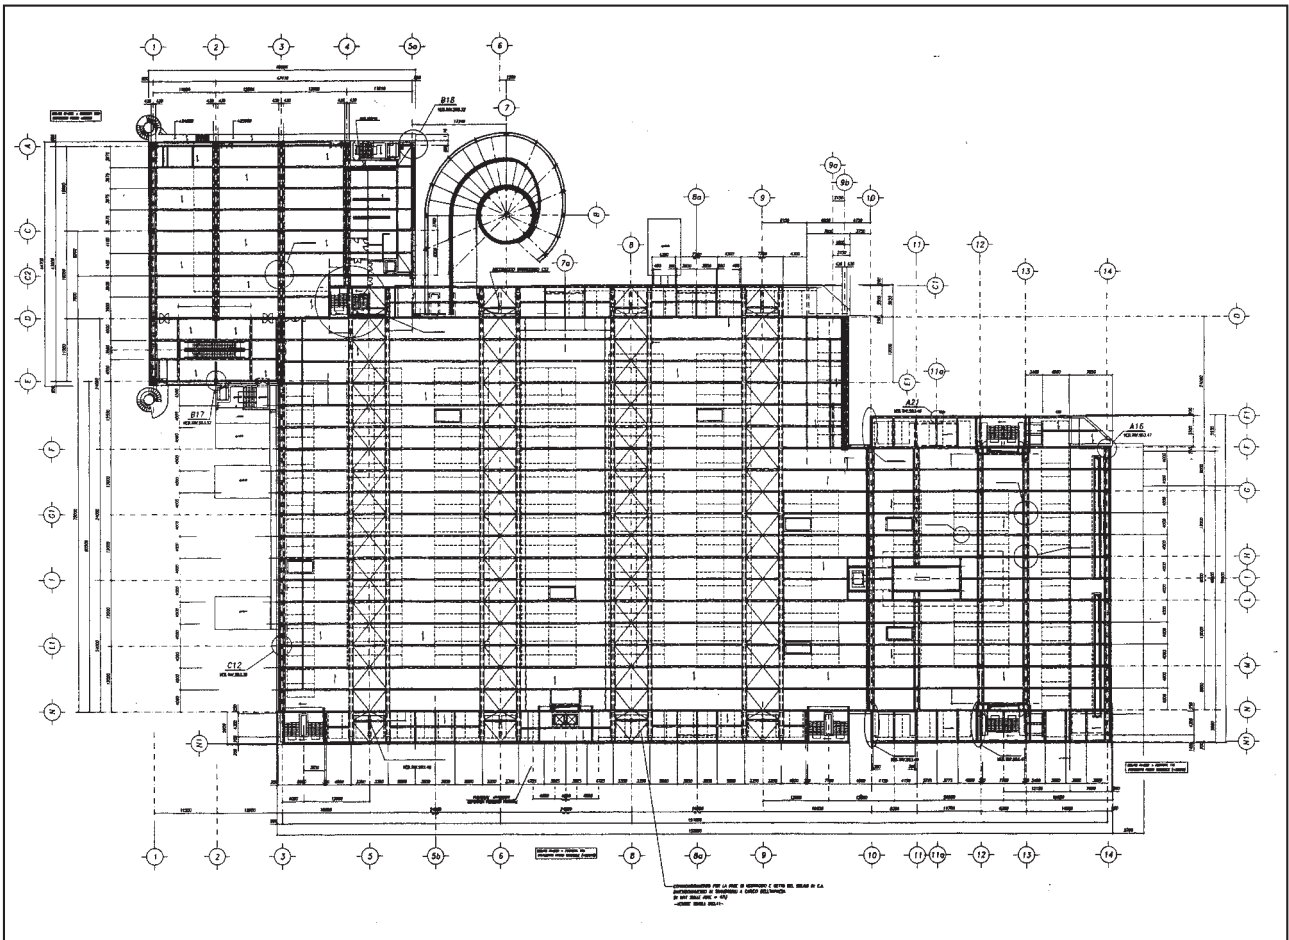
Pianta della struttura portante dell'impalcato principale a quota +12.00 m
